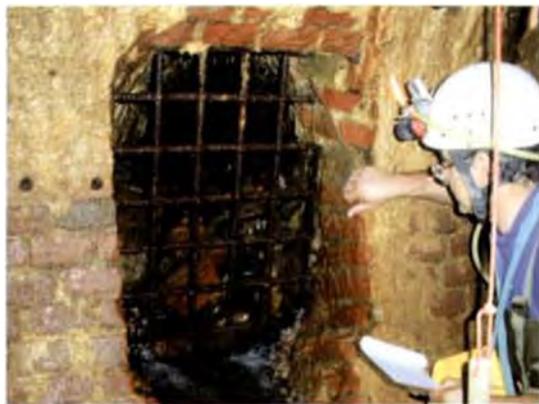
Innesto di una piccola condotta drenante posta verso il termine a monte: alcune evidenze farebbero supporre una sua costruzione successiva a quella della galleria principale (foto M. Chiesi).
